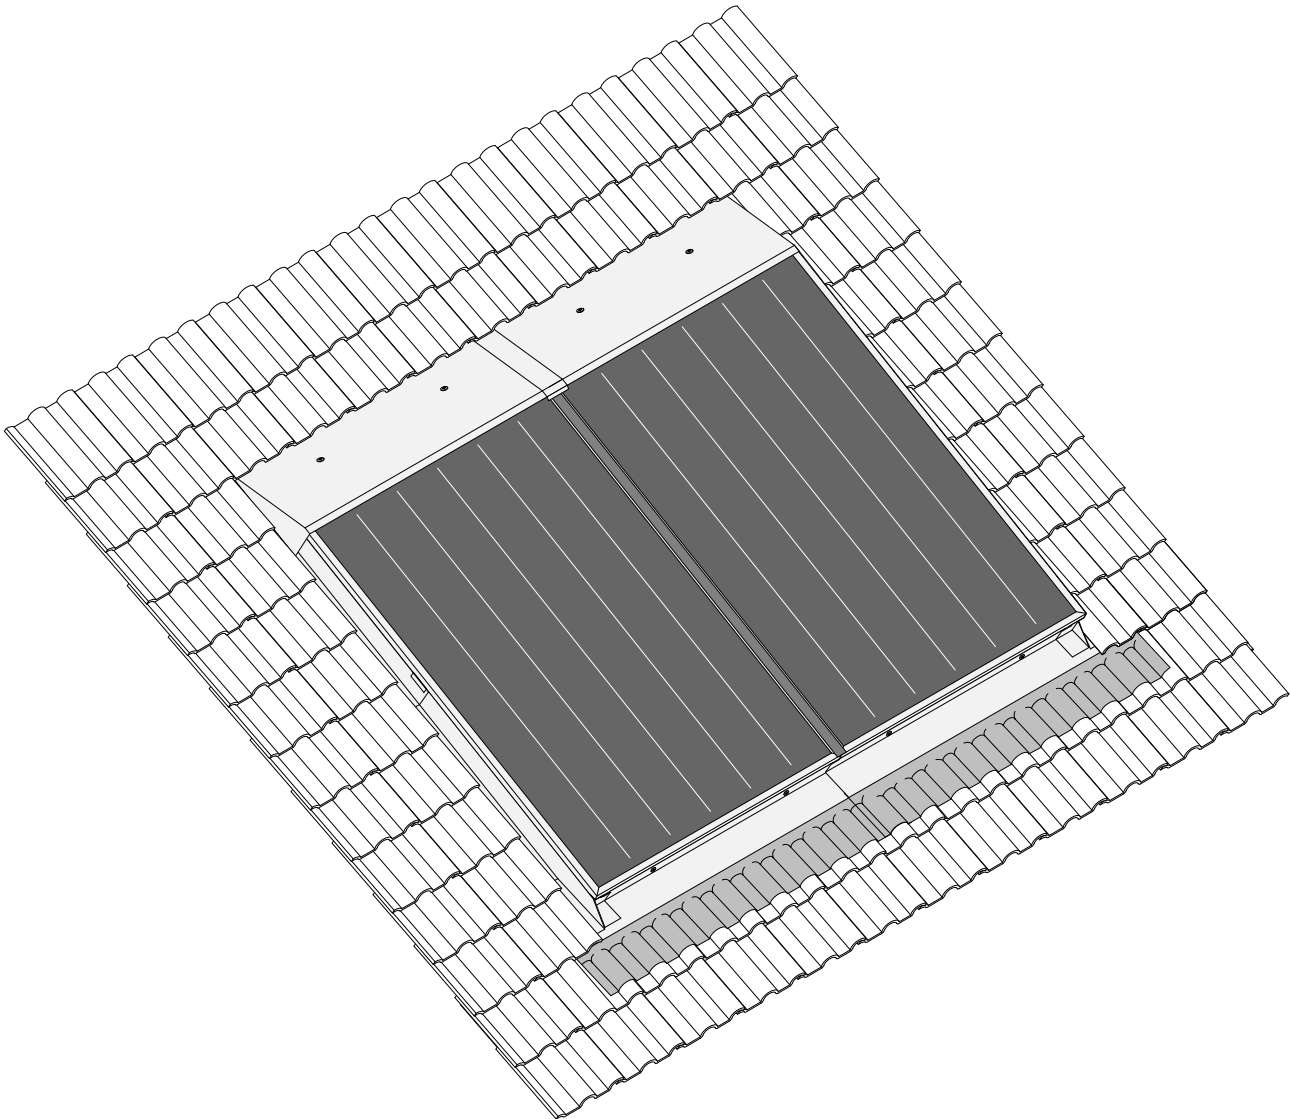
Fertig installierte EURO-Indacheinbindung auf Pfannendach.
